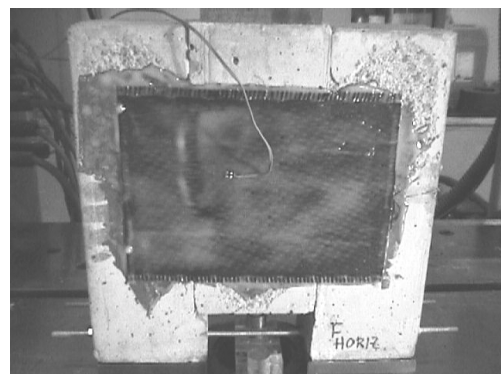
La presente foto muestra el lado "B" con la lamina instrumentada con la galga orientada con las fibras horizontales del tejido longitudinal de la lámina.
